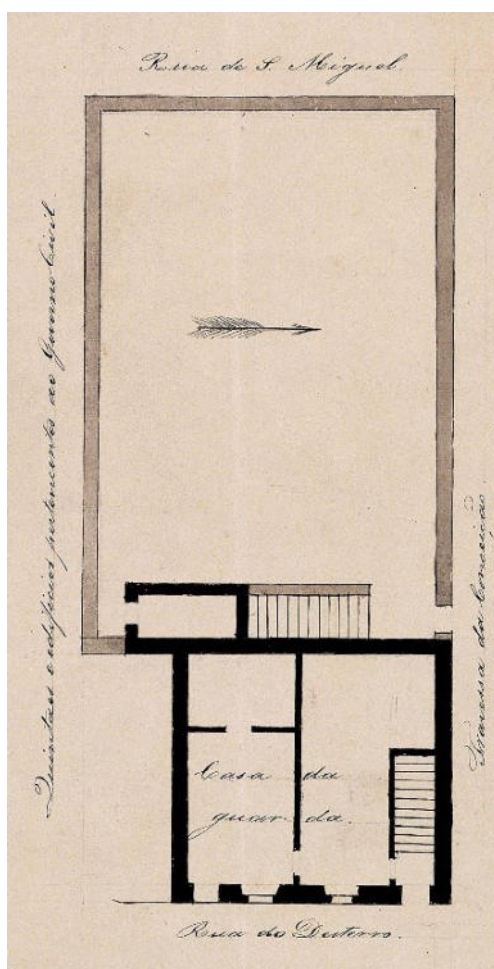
Detalhe da planta do Edifício da secretaria militar de 1863 (Anexo 19)
